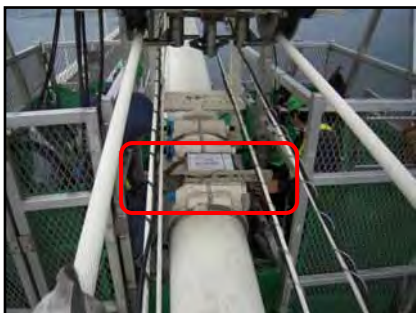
本橋専用軸力測長機設置状況 写真-6 本橋専用機器での軸力計測状況 写真-7 ボルトテンショナー設置状況
